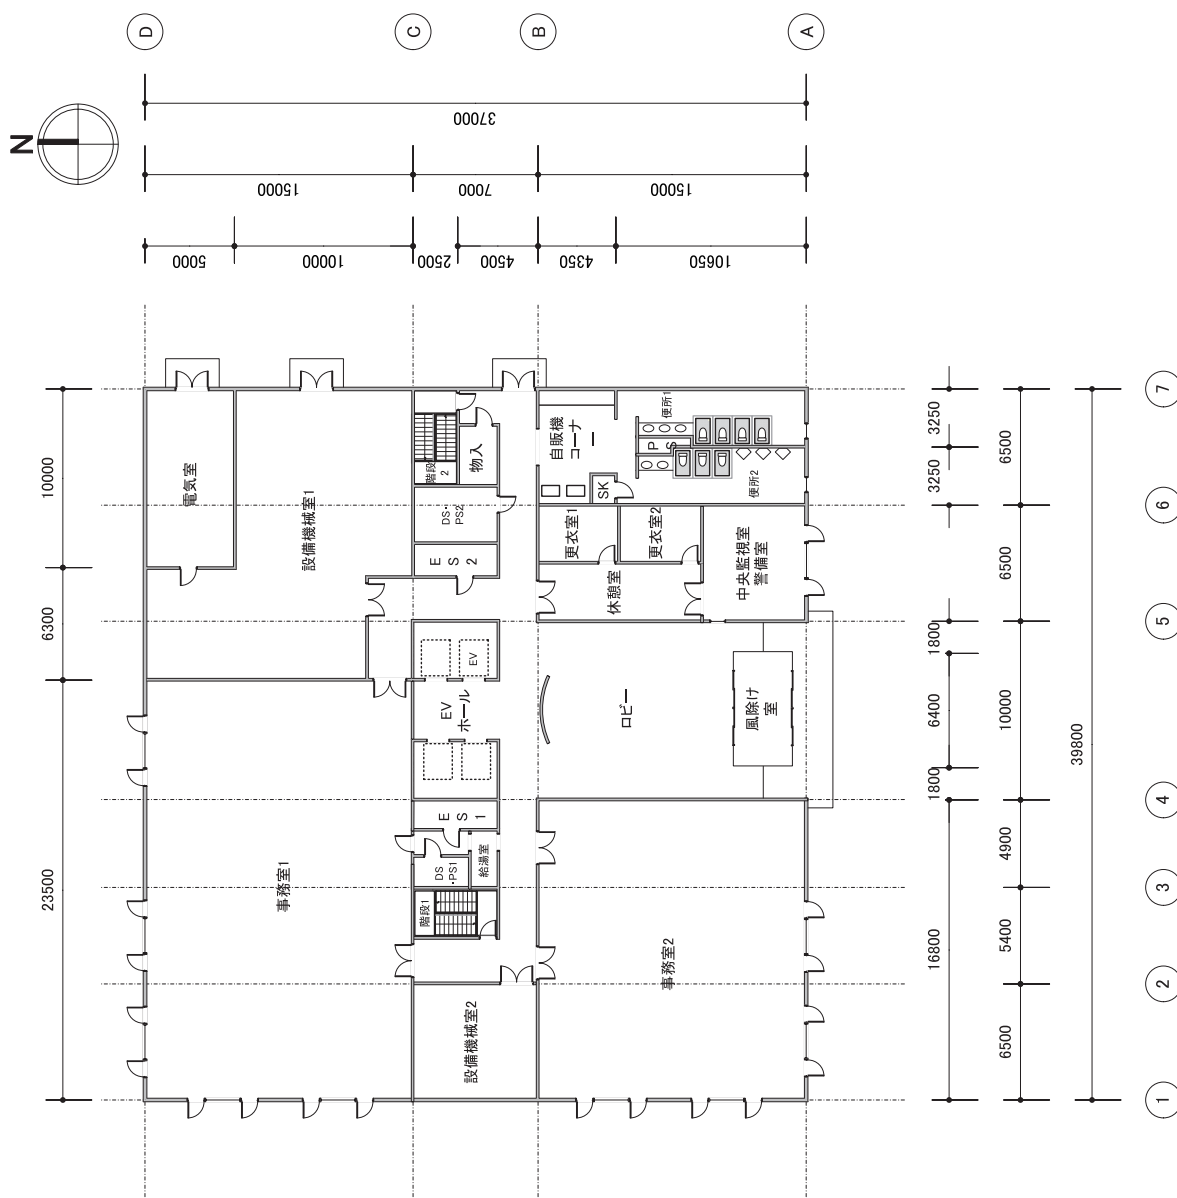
A.1 モデル建物 (事務所等、10,000 m<sup>2</sup>) 1 階平面図
